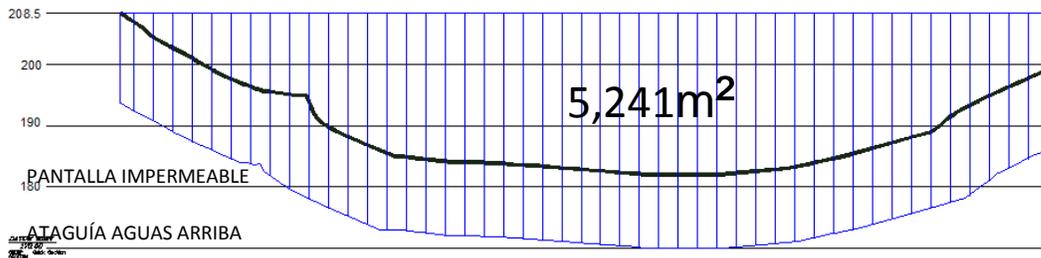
Pantalla Impermeable Ataguía Aguas Arriba corte longitudinal
